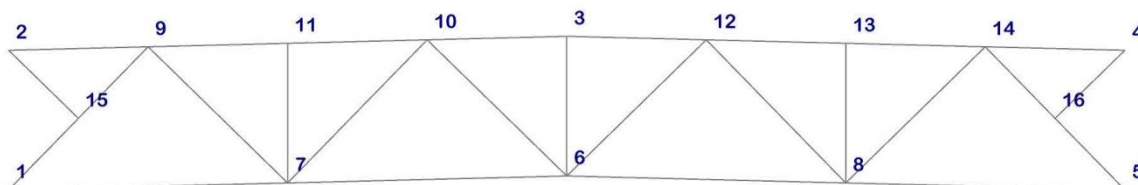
Номера узлов фермы ФС-24-45, принятые в расчете
